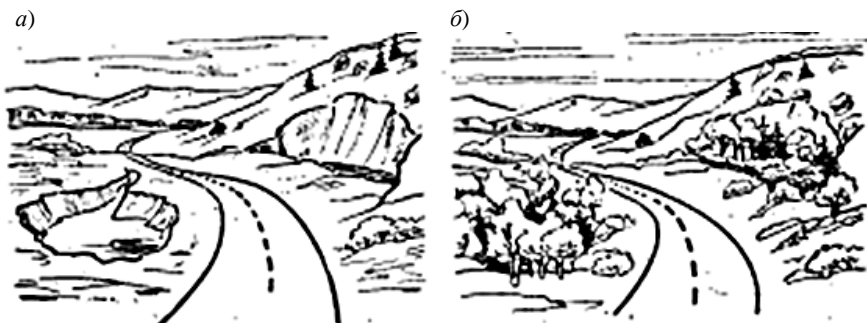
Маскировка некрасивых выработок грунтового карьера декоративными посадками [41]:
